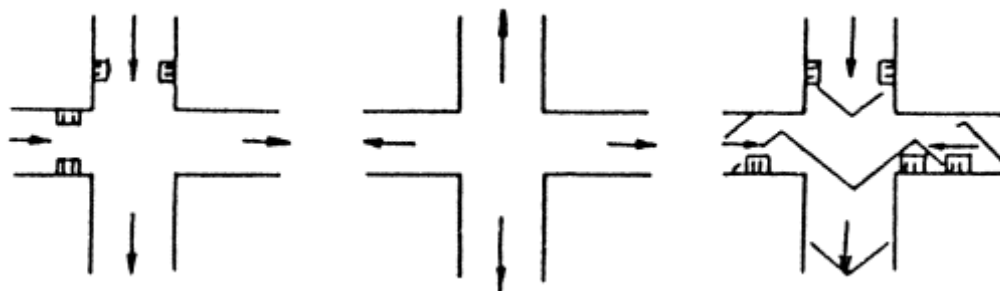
Схемы размещения водоприемных колодцев на перекрестках улиц
